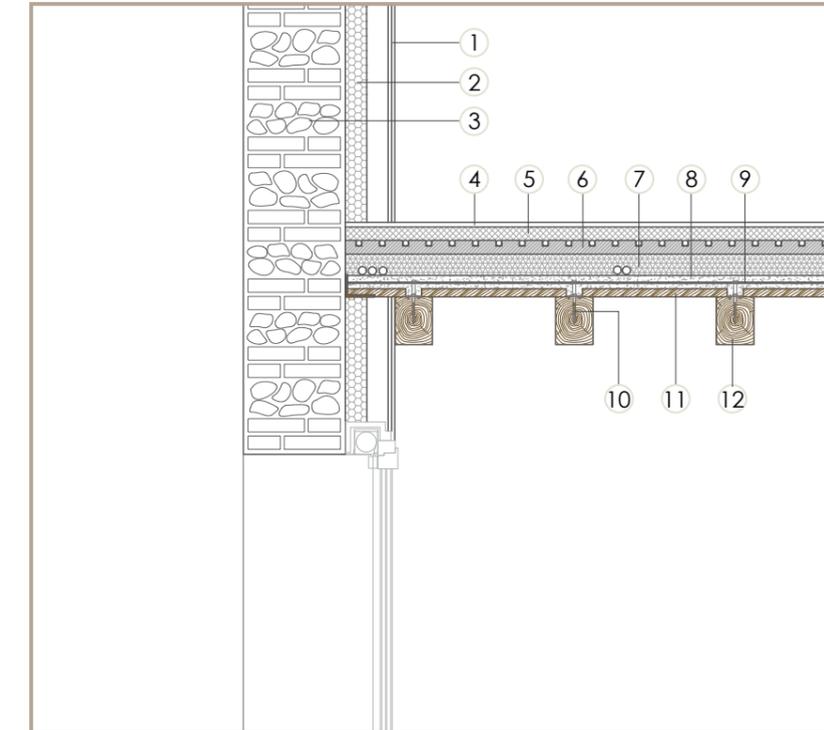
Dettaglio nodo muratura - solaio, fuori scala
